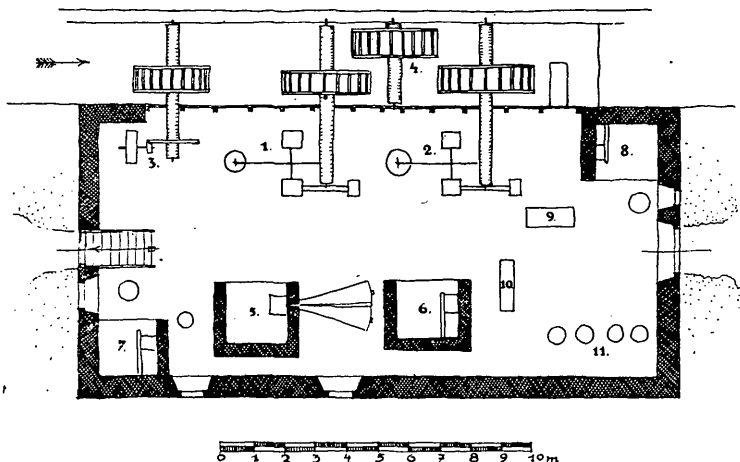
Plan des Sensenhammers im Furt zu Leonstein. Umgebaut um 1750.
